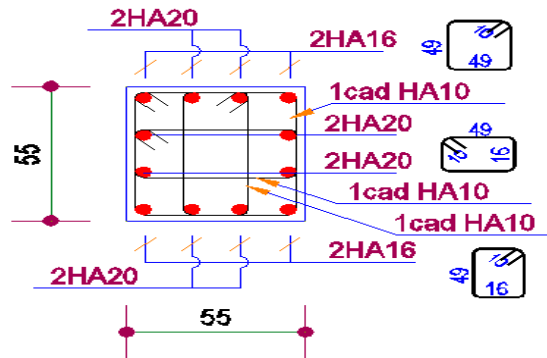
Schéma de ferrailage des poteaux du 4^{ème} et 5^{ème} étage
